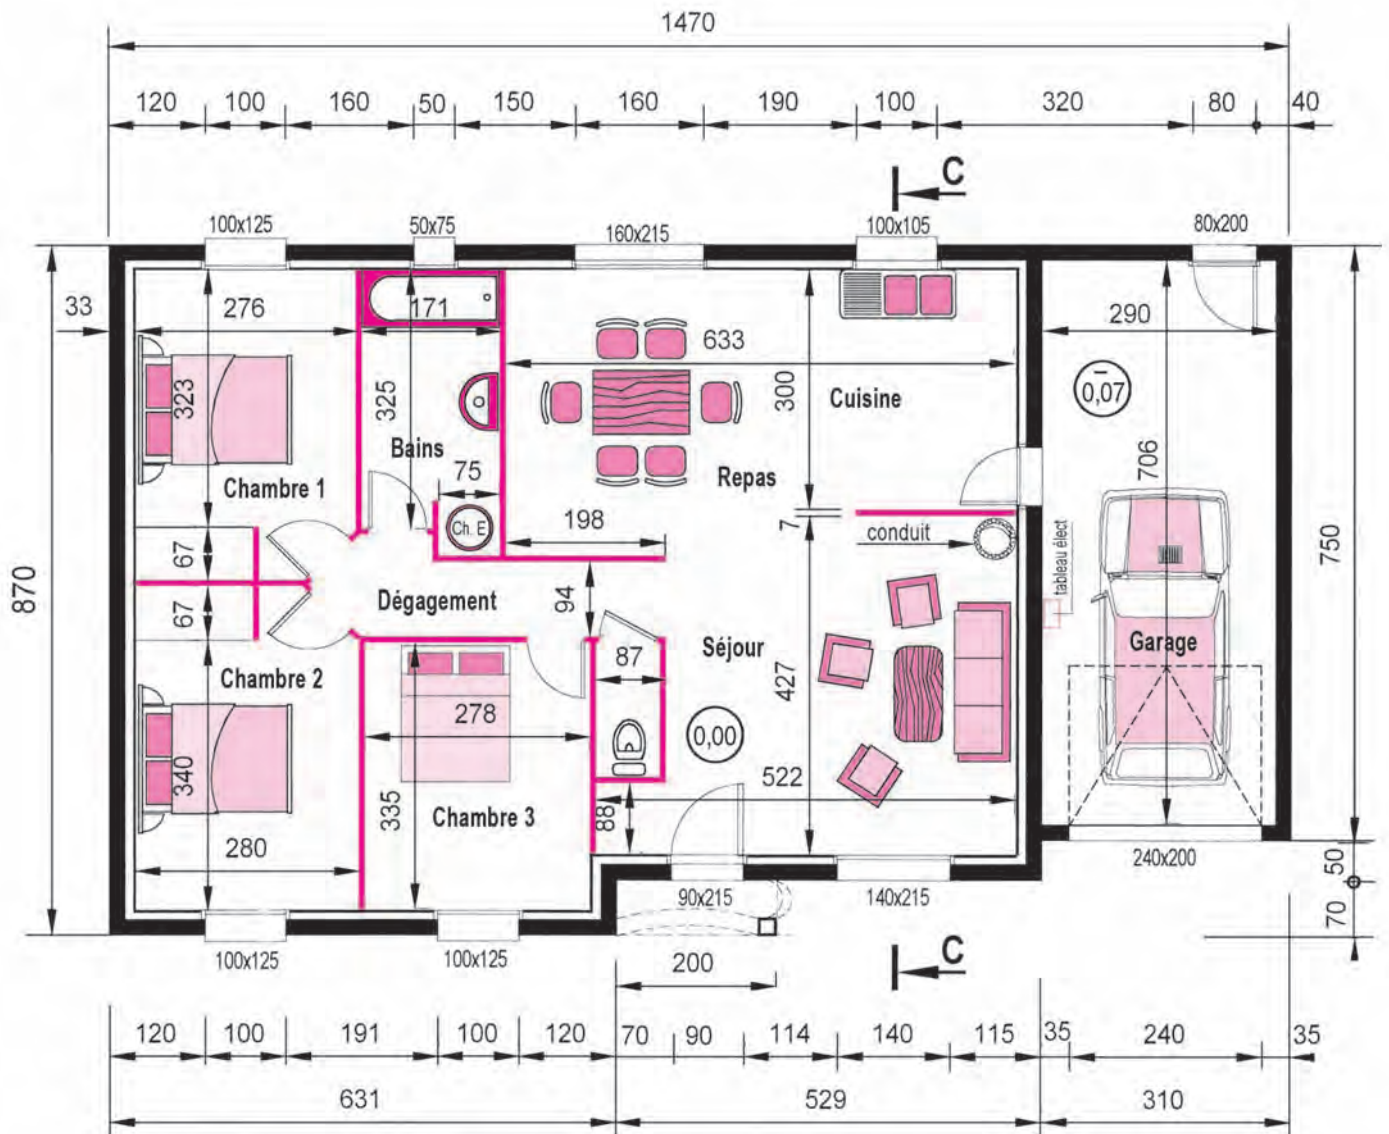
Plan de la maison de plain-pied, type 4/5, avec garage en annexe
